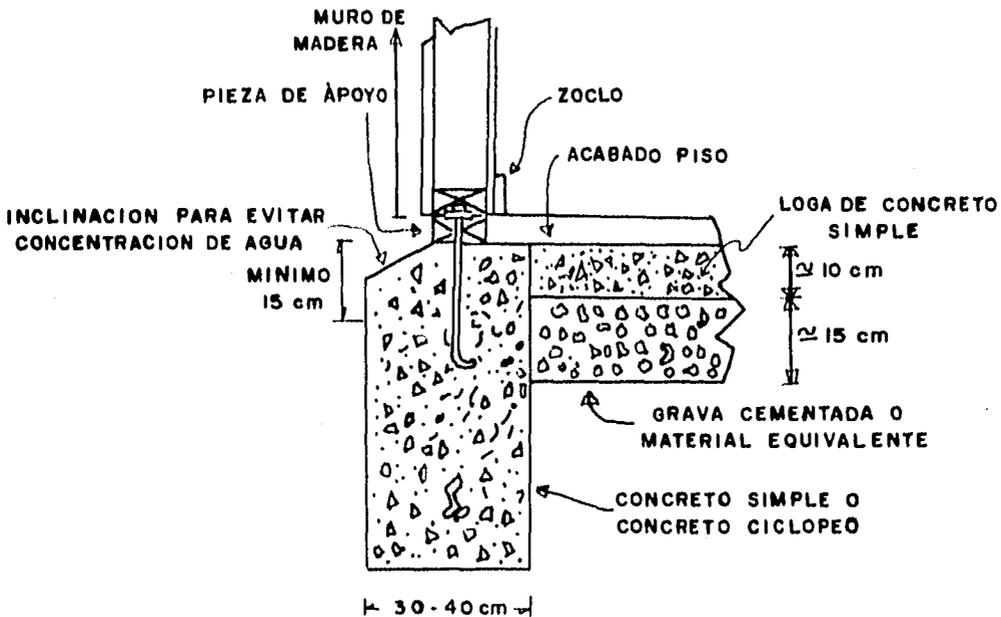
FIGURA CIMENTACION CORRIDA DE CONCRETO SIMPLE O CICLOPEO COLADO EN ZANJA HECHA CON EXCAVADORA MECANICA
